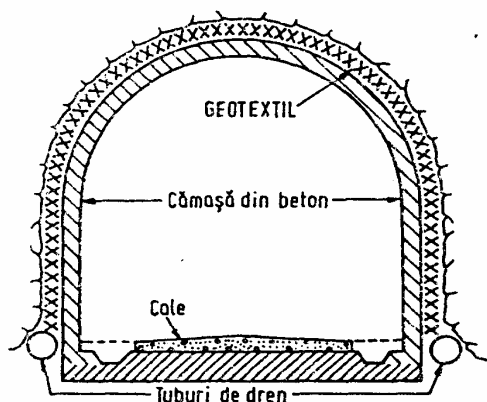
Sistem de drenaj perimetral cu geotextil la tuneluri
